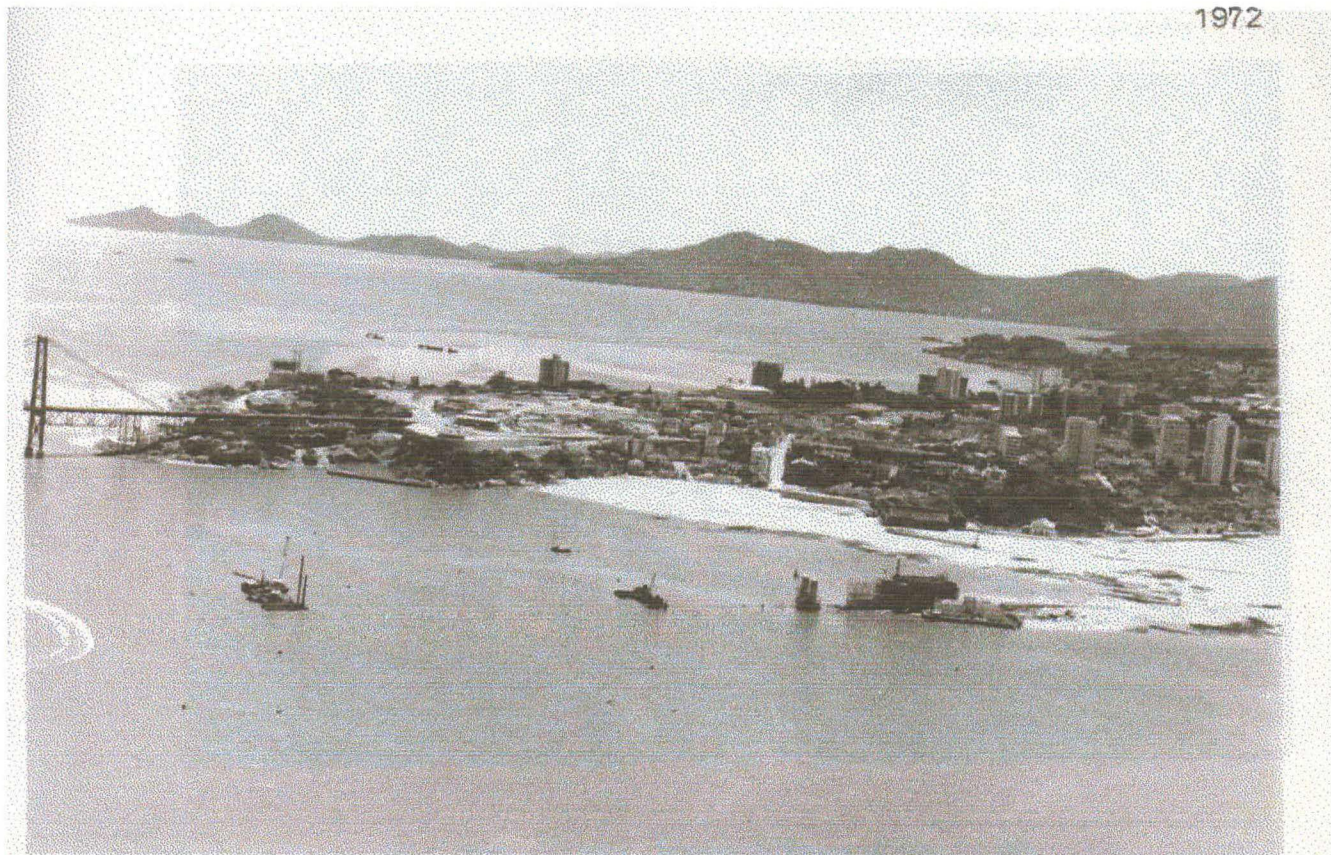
Início do aterramento hidráulico na Baía Sul e da construção da Ponte Colombo Salles.
